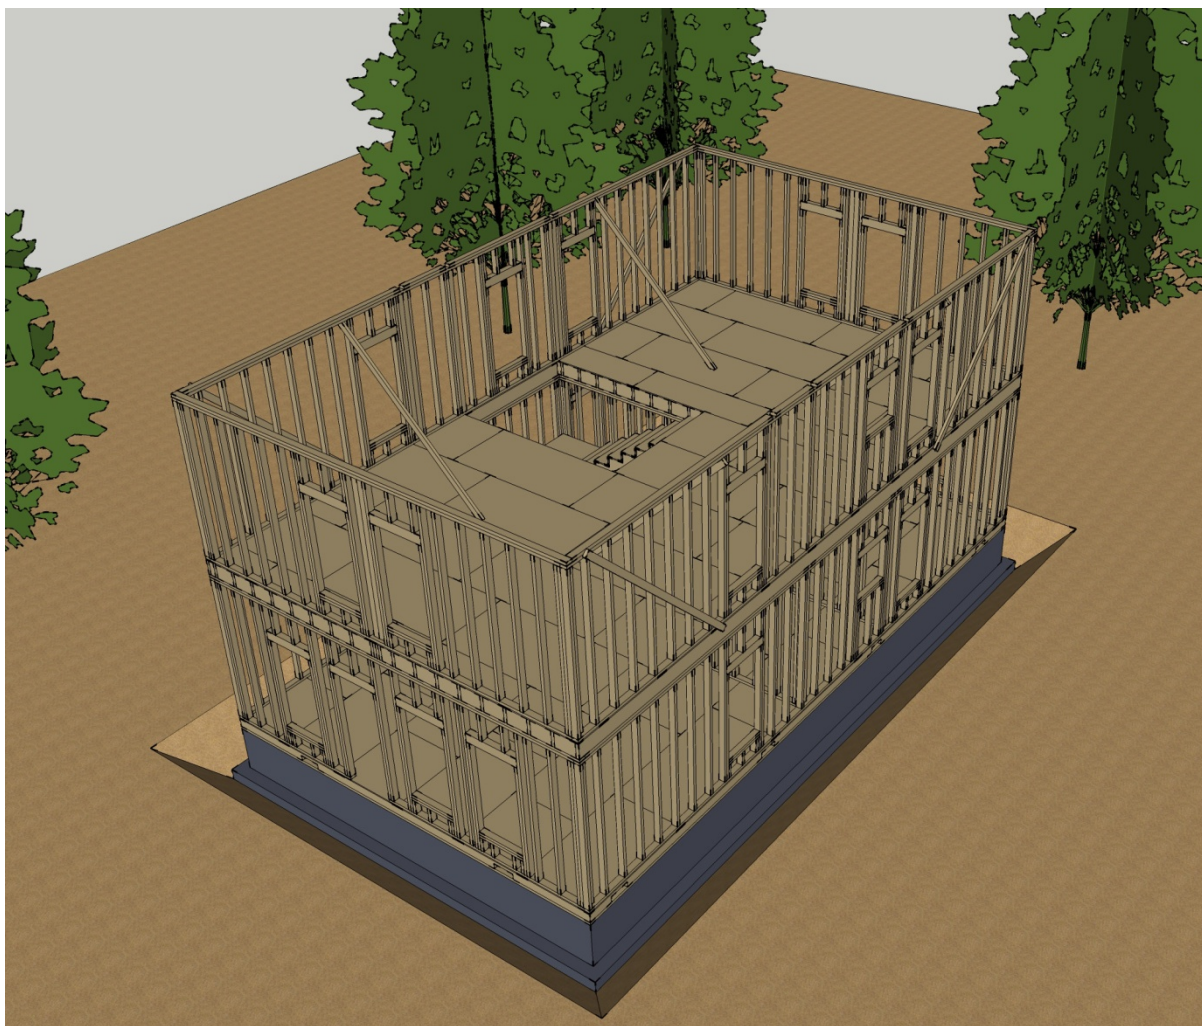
Montagem das paredes exteriores (de topo) ao pavimento e às paredes exteriores longitudinais.
